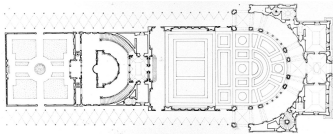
Giacomo Vignola, *Villa Giulia*, Planta Tipo, 1551
